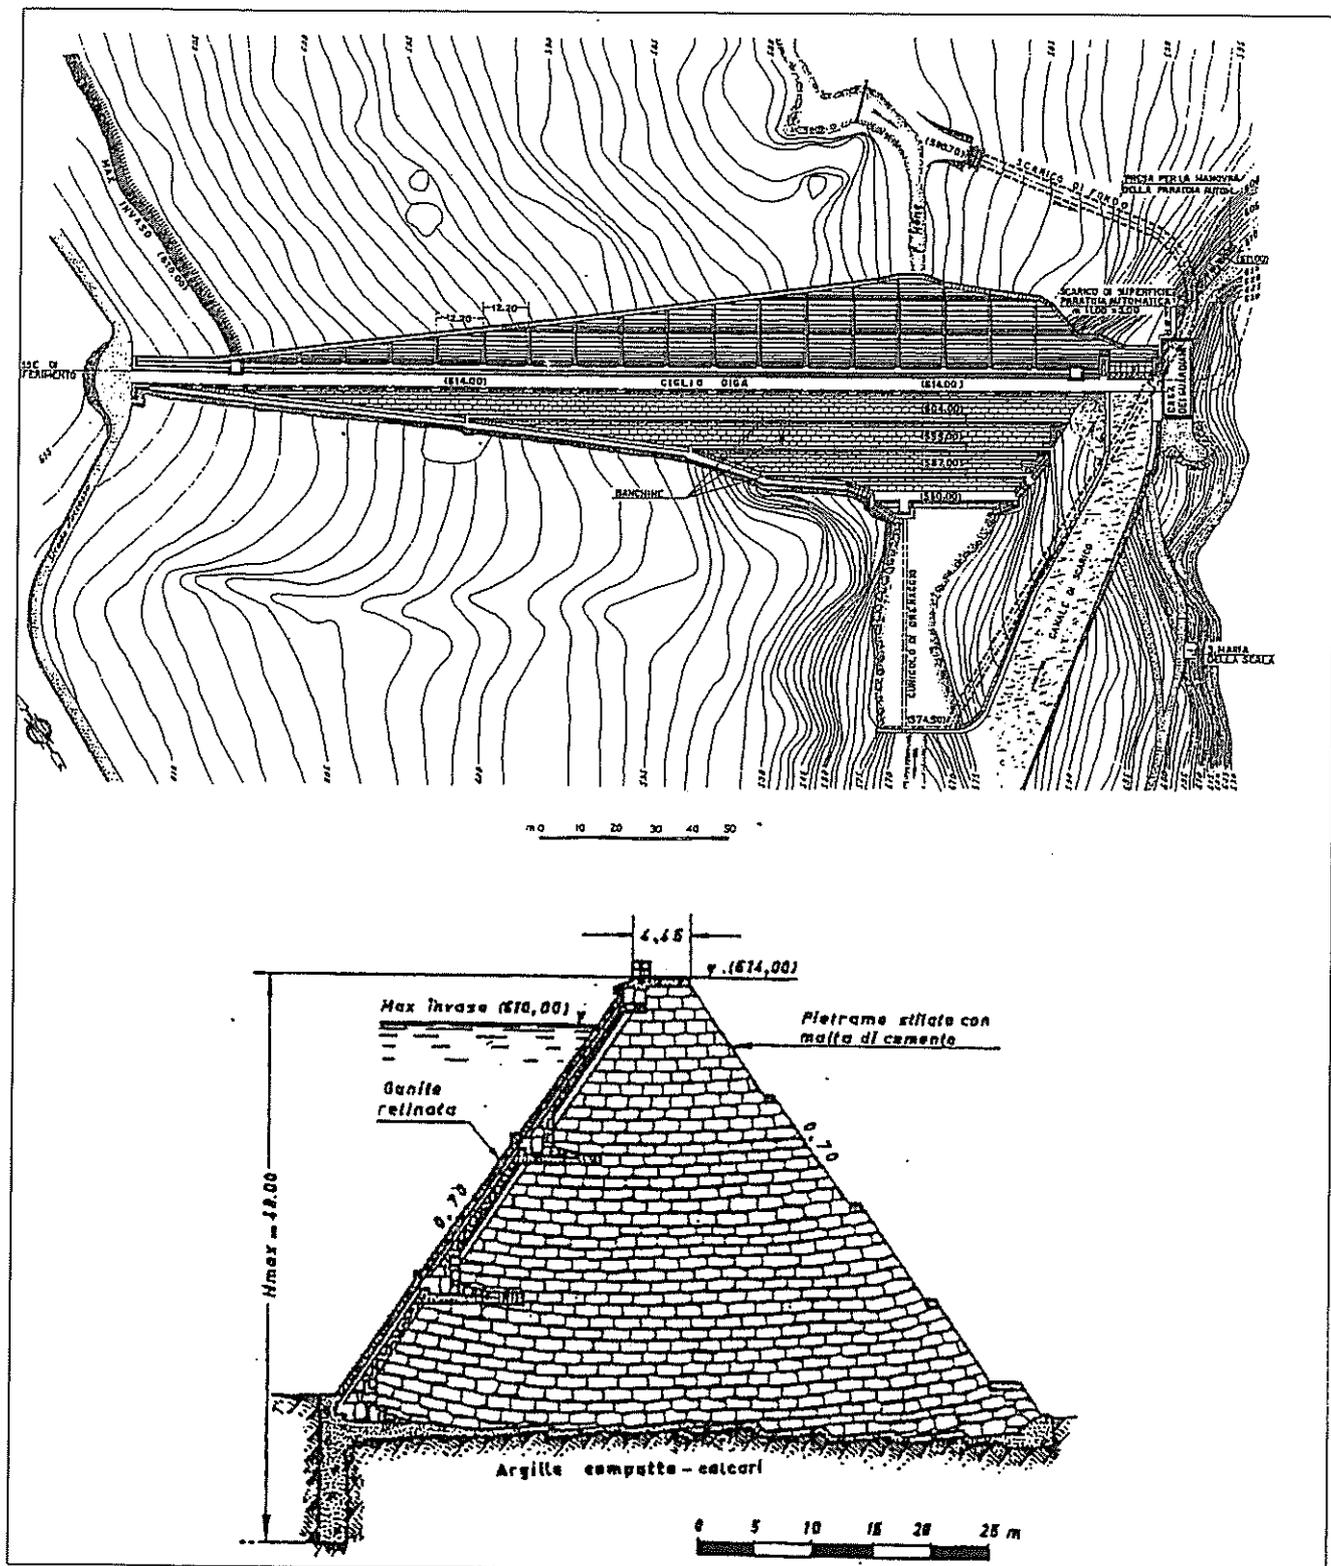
Diga della Piana dei Greci: Planimetria - Sezione tipo.
